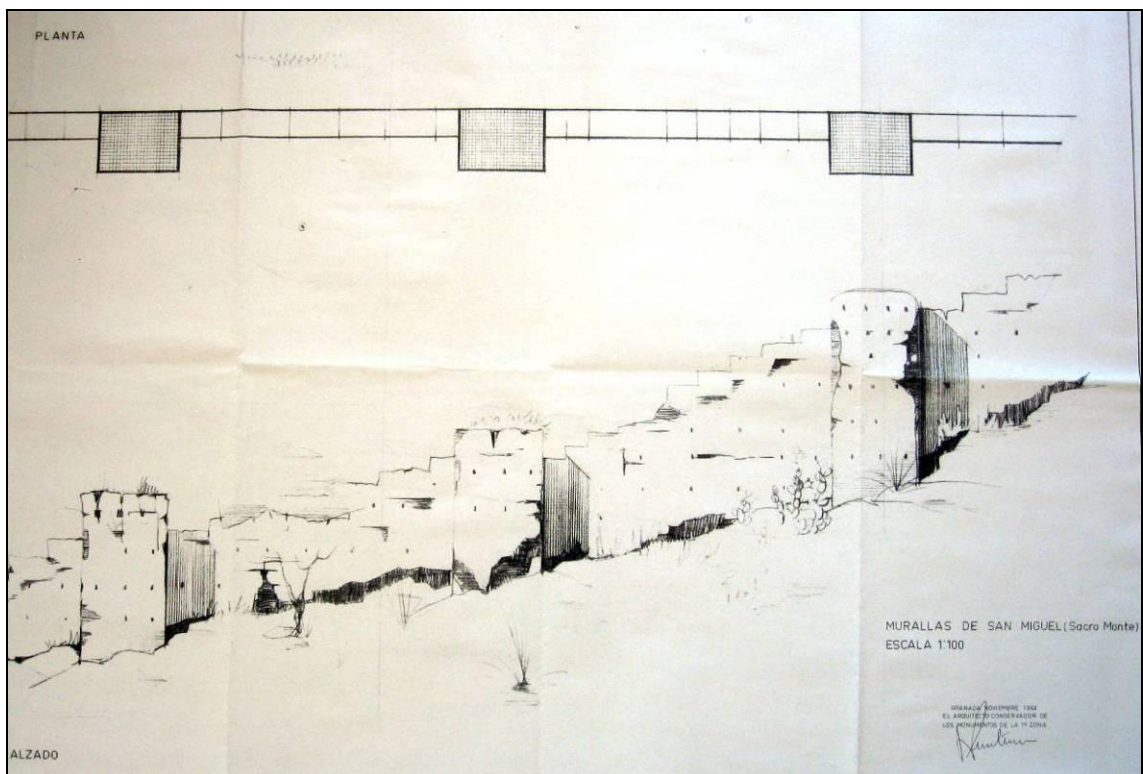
Prieto-Moreno. Murallas del Albaicín. Sector de San Miguel Alto. Alzado (1963) AGA (Sección Cultura, 26/367)
